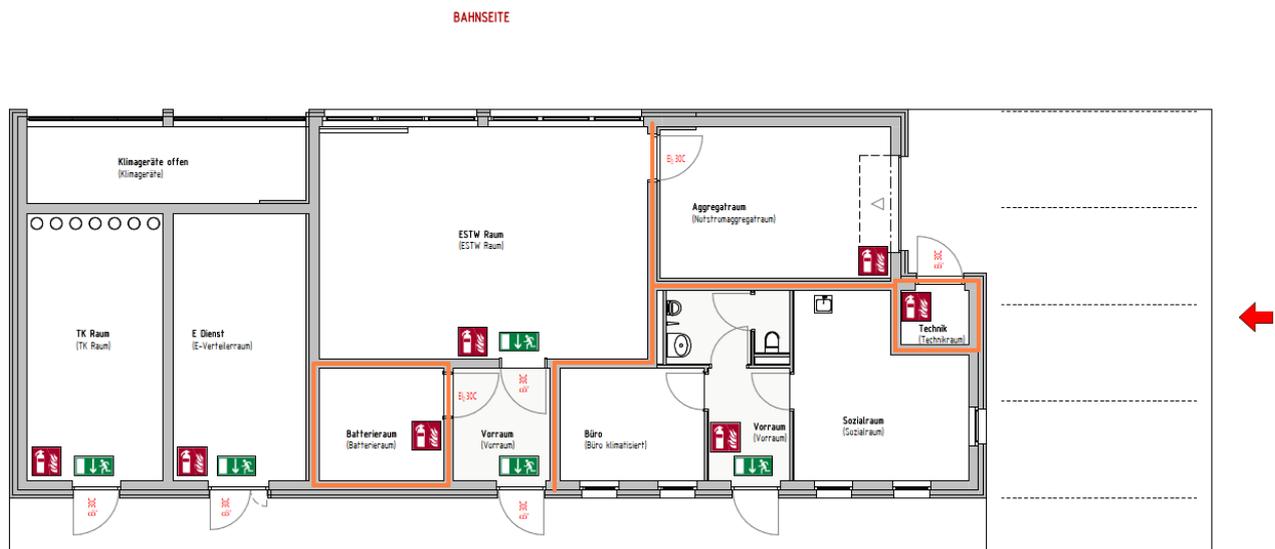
Grundriss ESTW-Technikgebäude (Quelle: Einlage5203)
